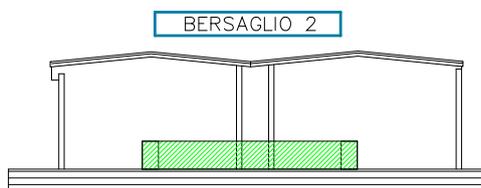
Determinazione delle piastre radianti sul piano radiante 2.
